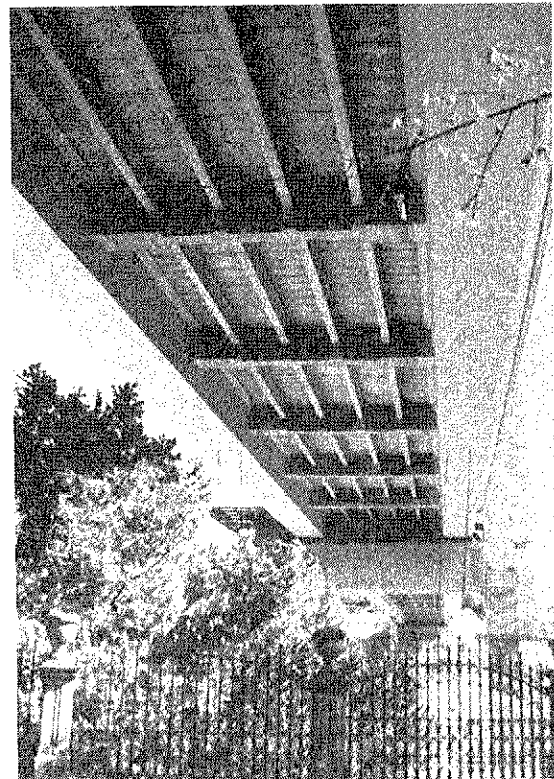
Artesonado inferior con vigas riostra y viguetas.
